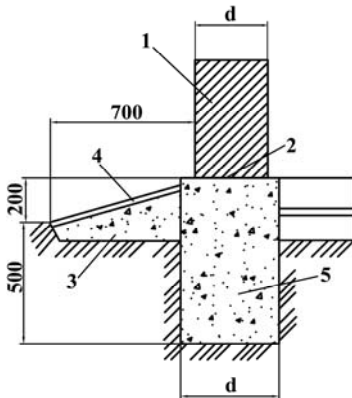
Стрічковий фундамент з бетону та бутобетону:
